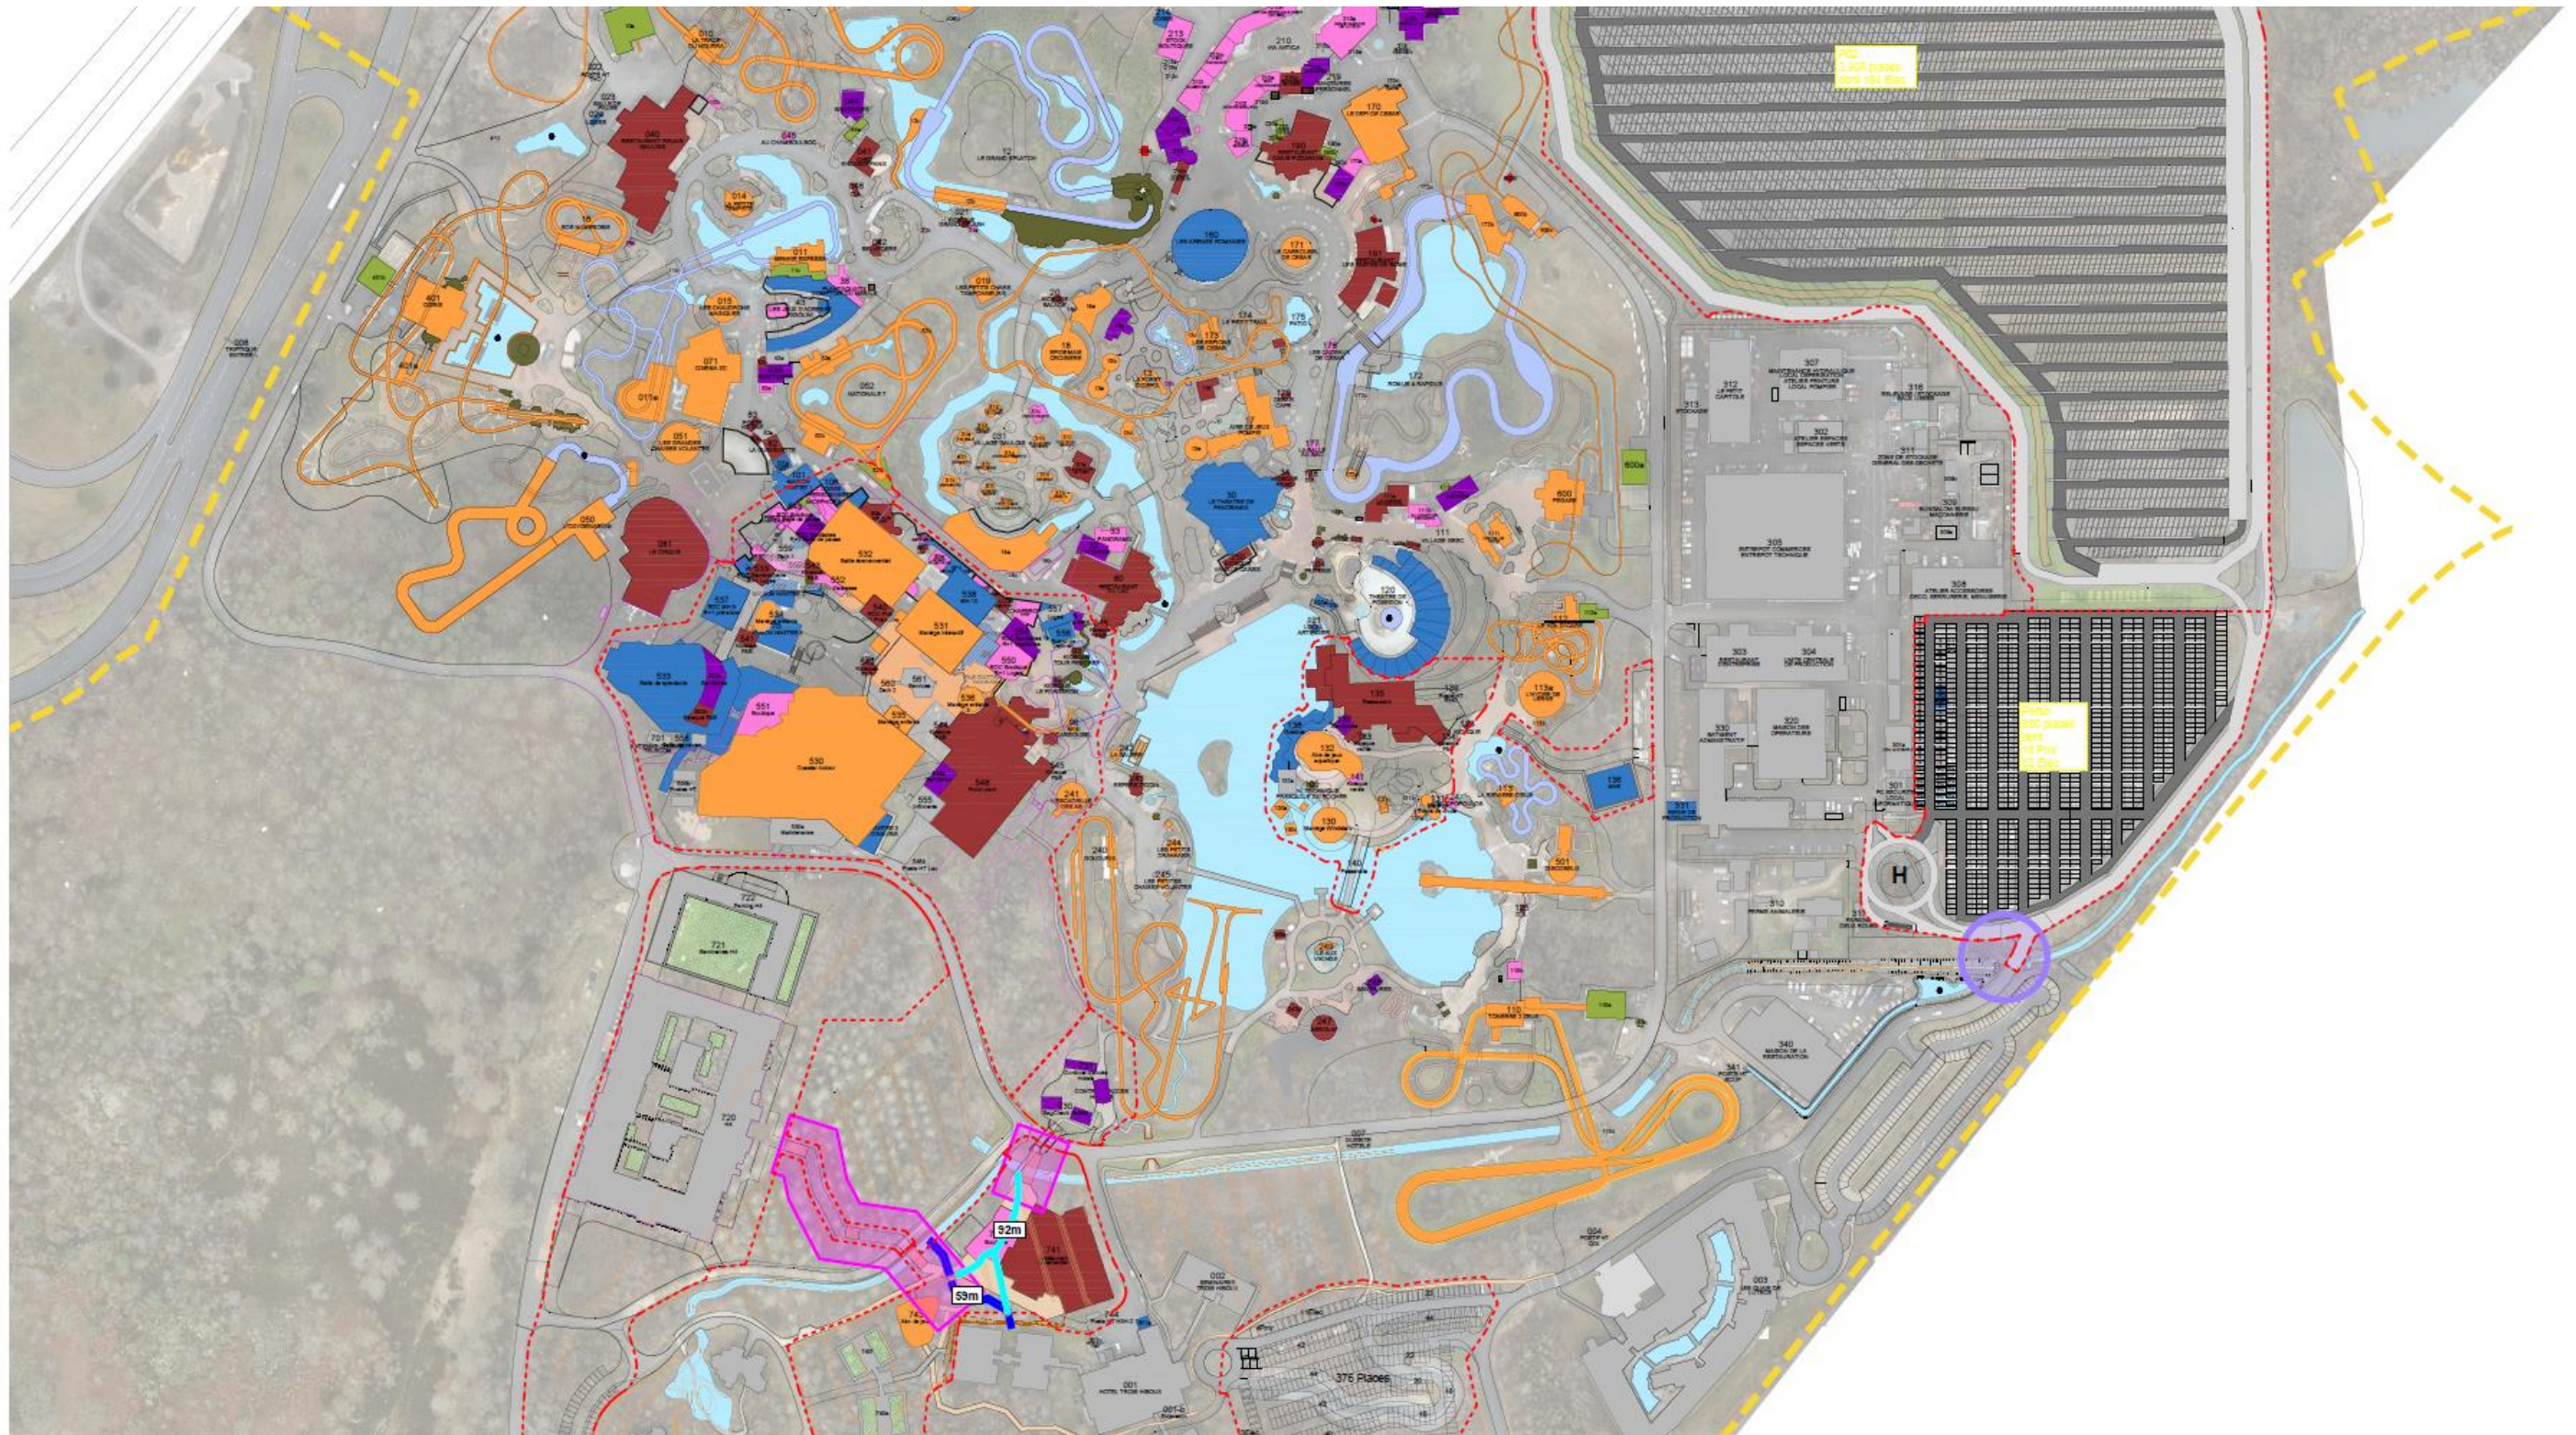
Plan de localisation des ouvrages- Plan 2/3 (Parc Astérix)
